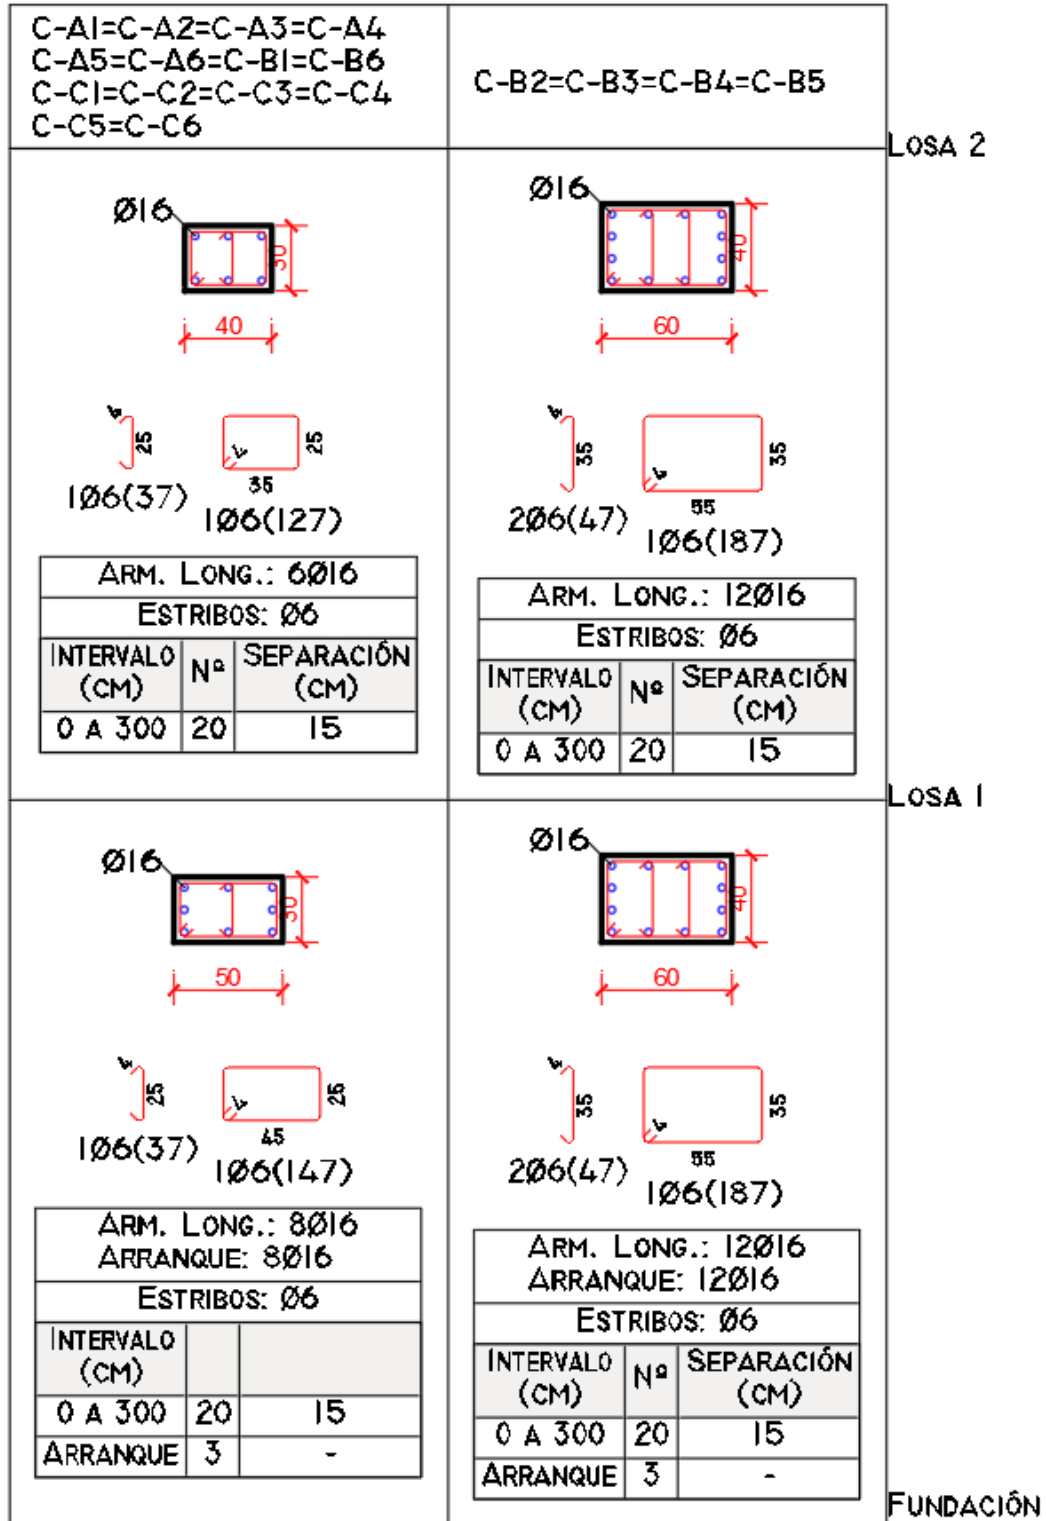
Detalle de Refuerzo Columnas, de Fundación a Losa 2, Estructura [7N-SS].
